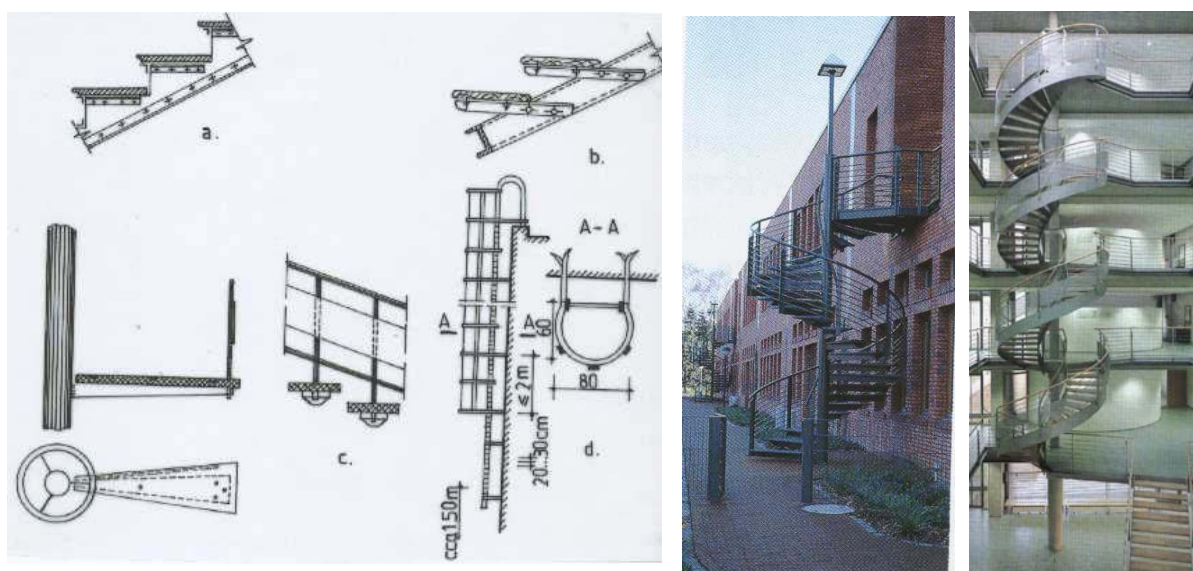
Scari metalice – detalii constructive (a)
